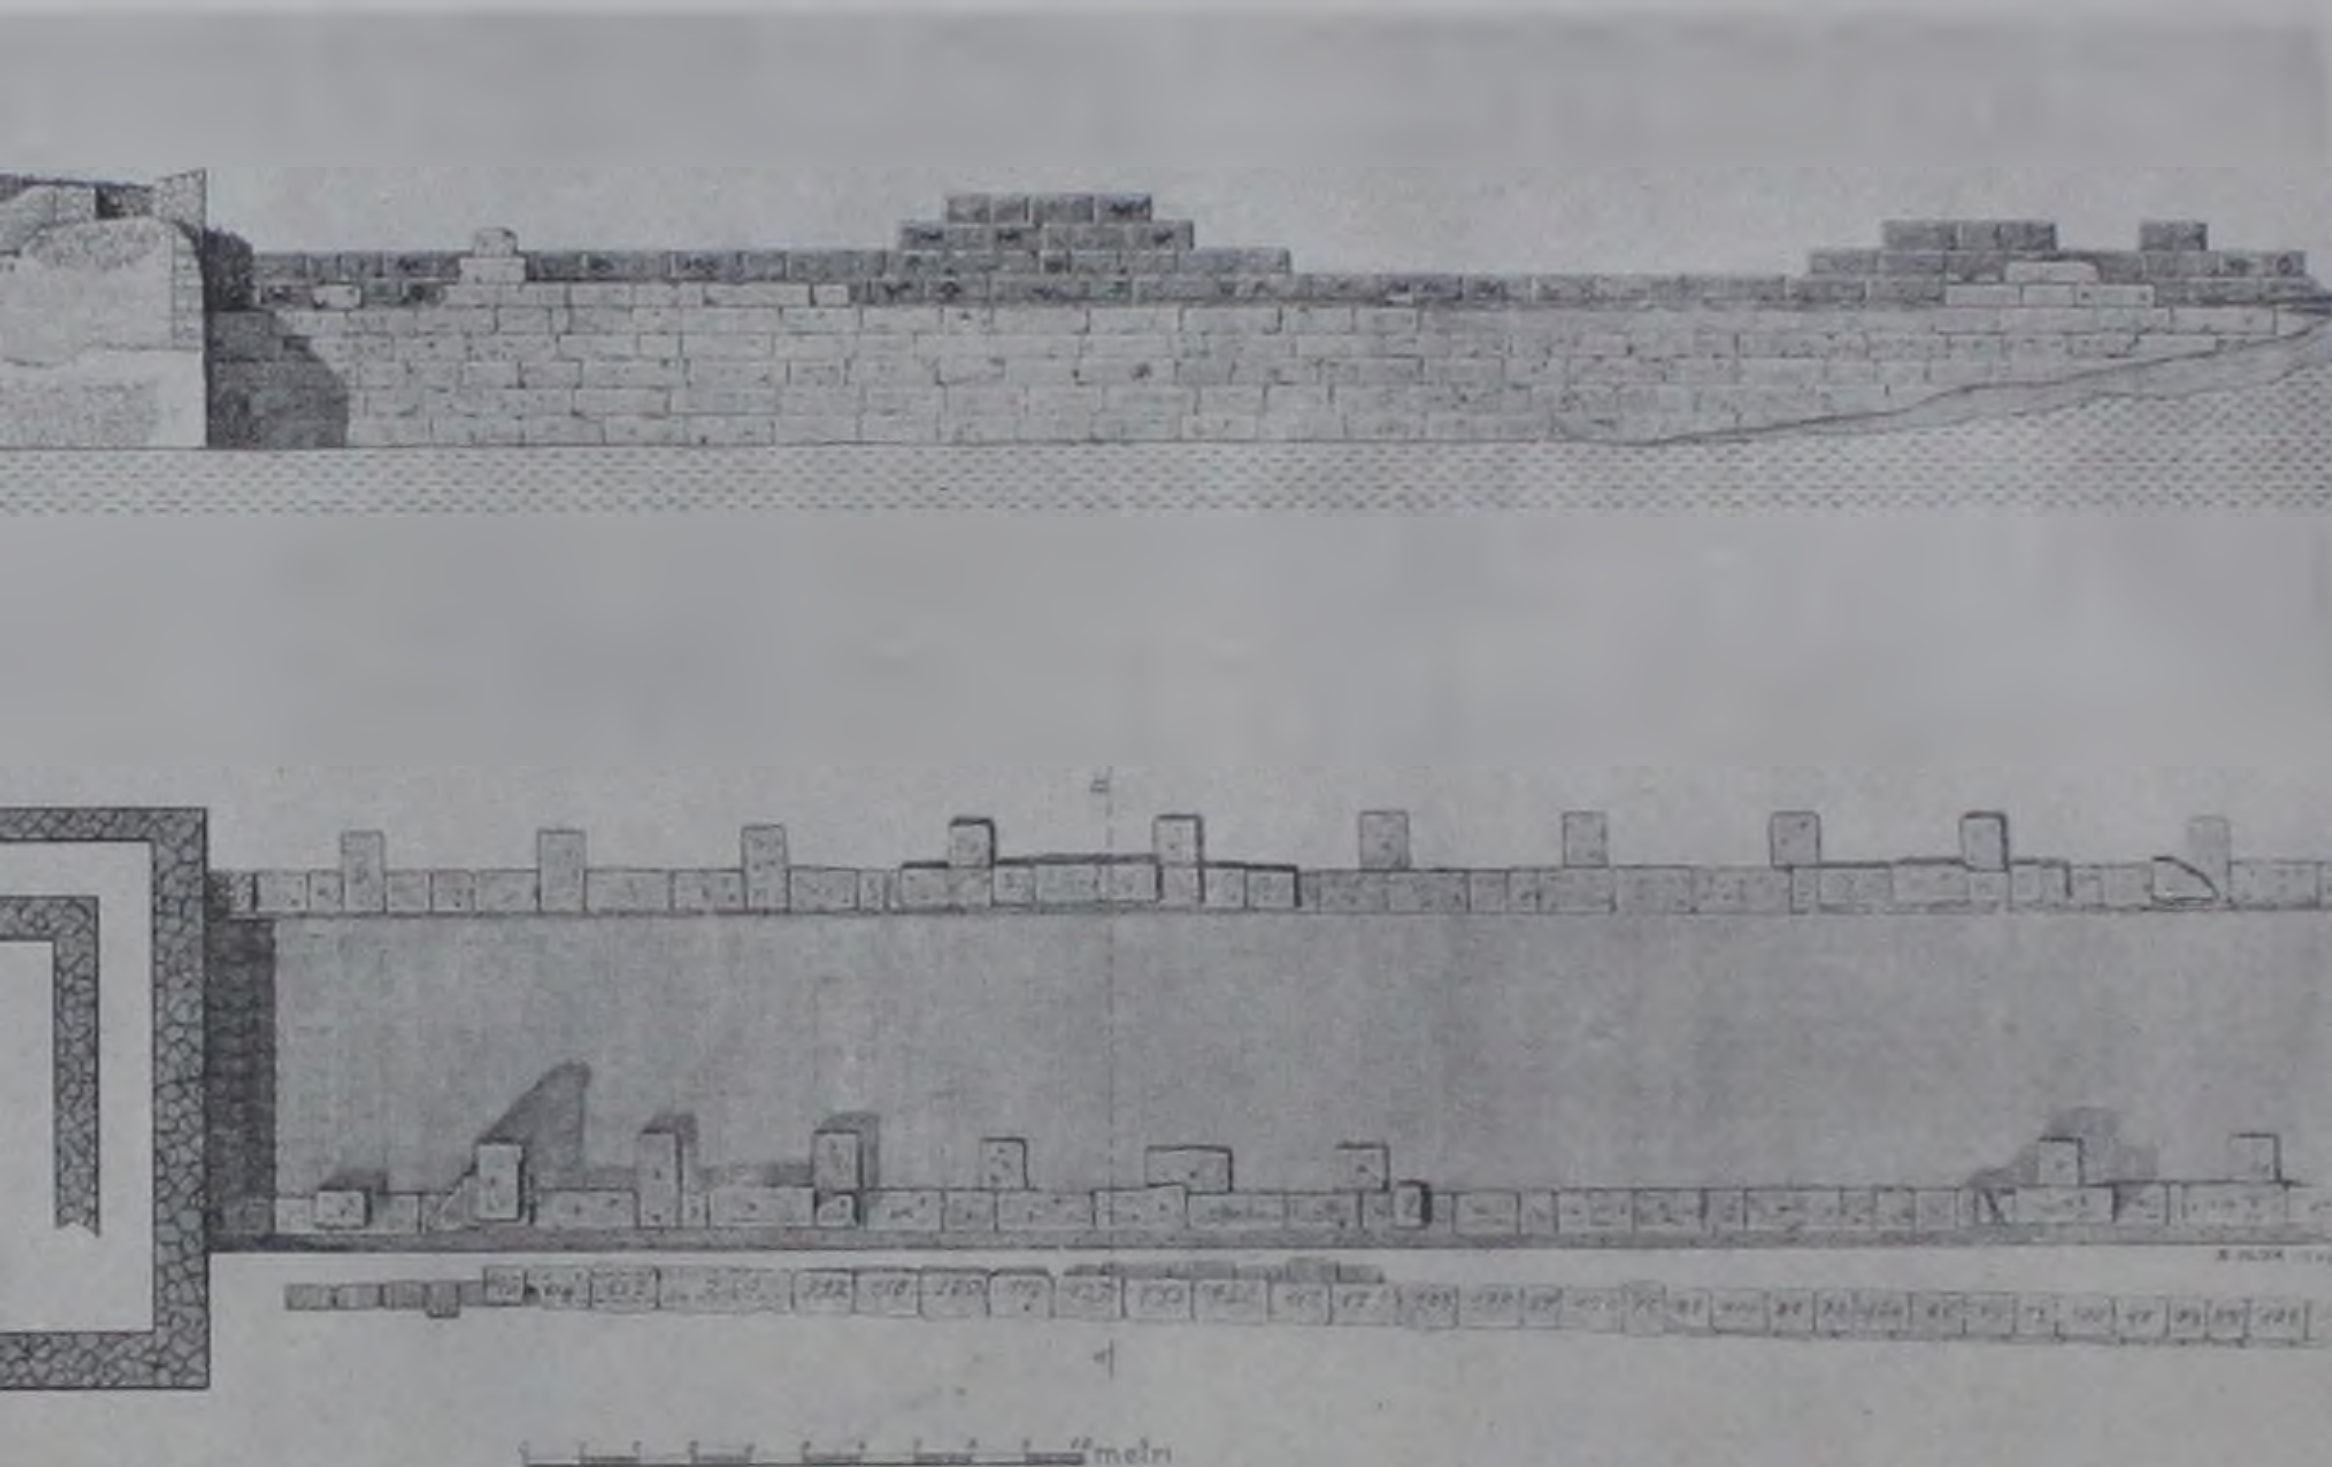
Pianta e alzato della cortina murale (a sud della Palestra).
